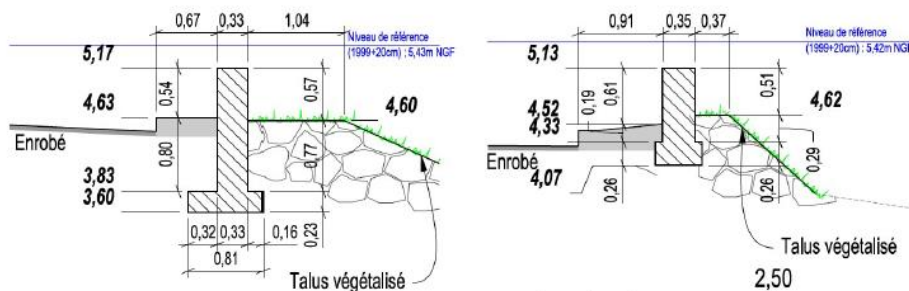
Profils en travers des murets béton sur le tronçon 3
